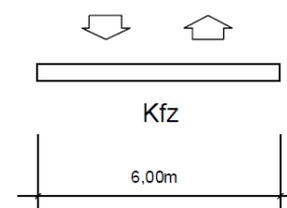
Querschnitt Planstraße B (Privatstraße)
